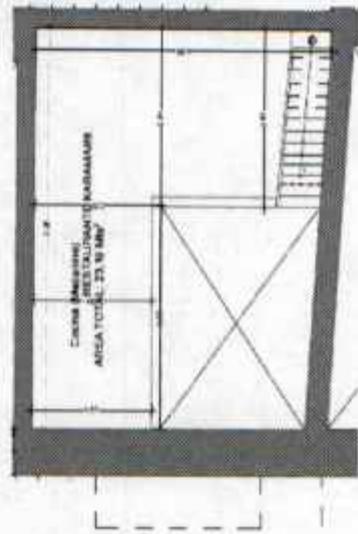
Plano RESTAURANTE KARAMAIRI -Área privada
